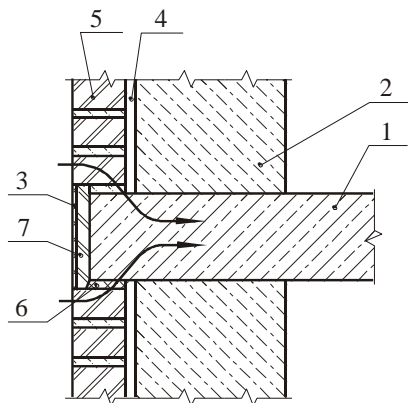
Вариант сопряжения лицевого слоя с плитой перекрытия:
